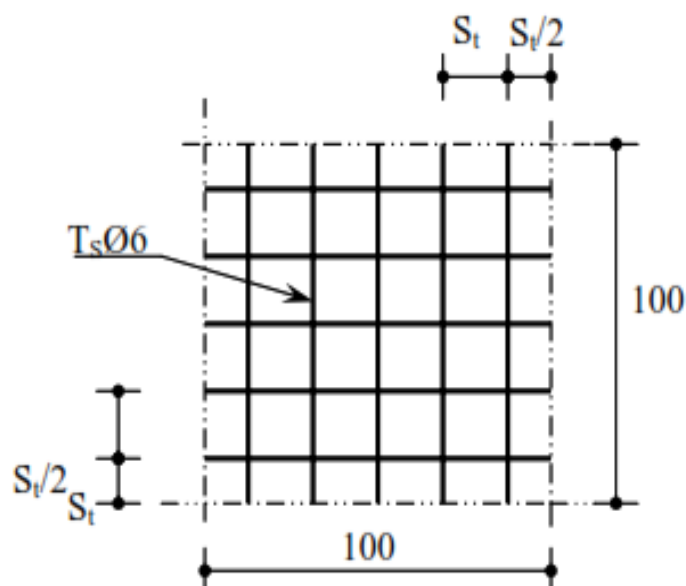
Disposition constructive des armatures de la dalle de compression
